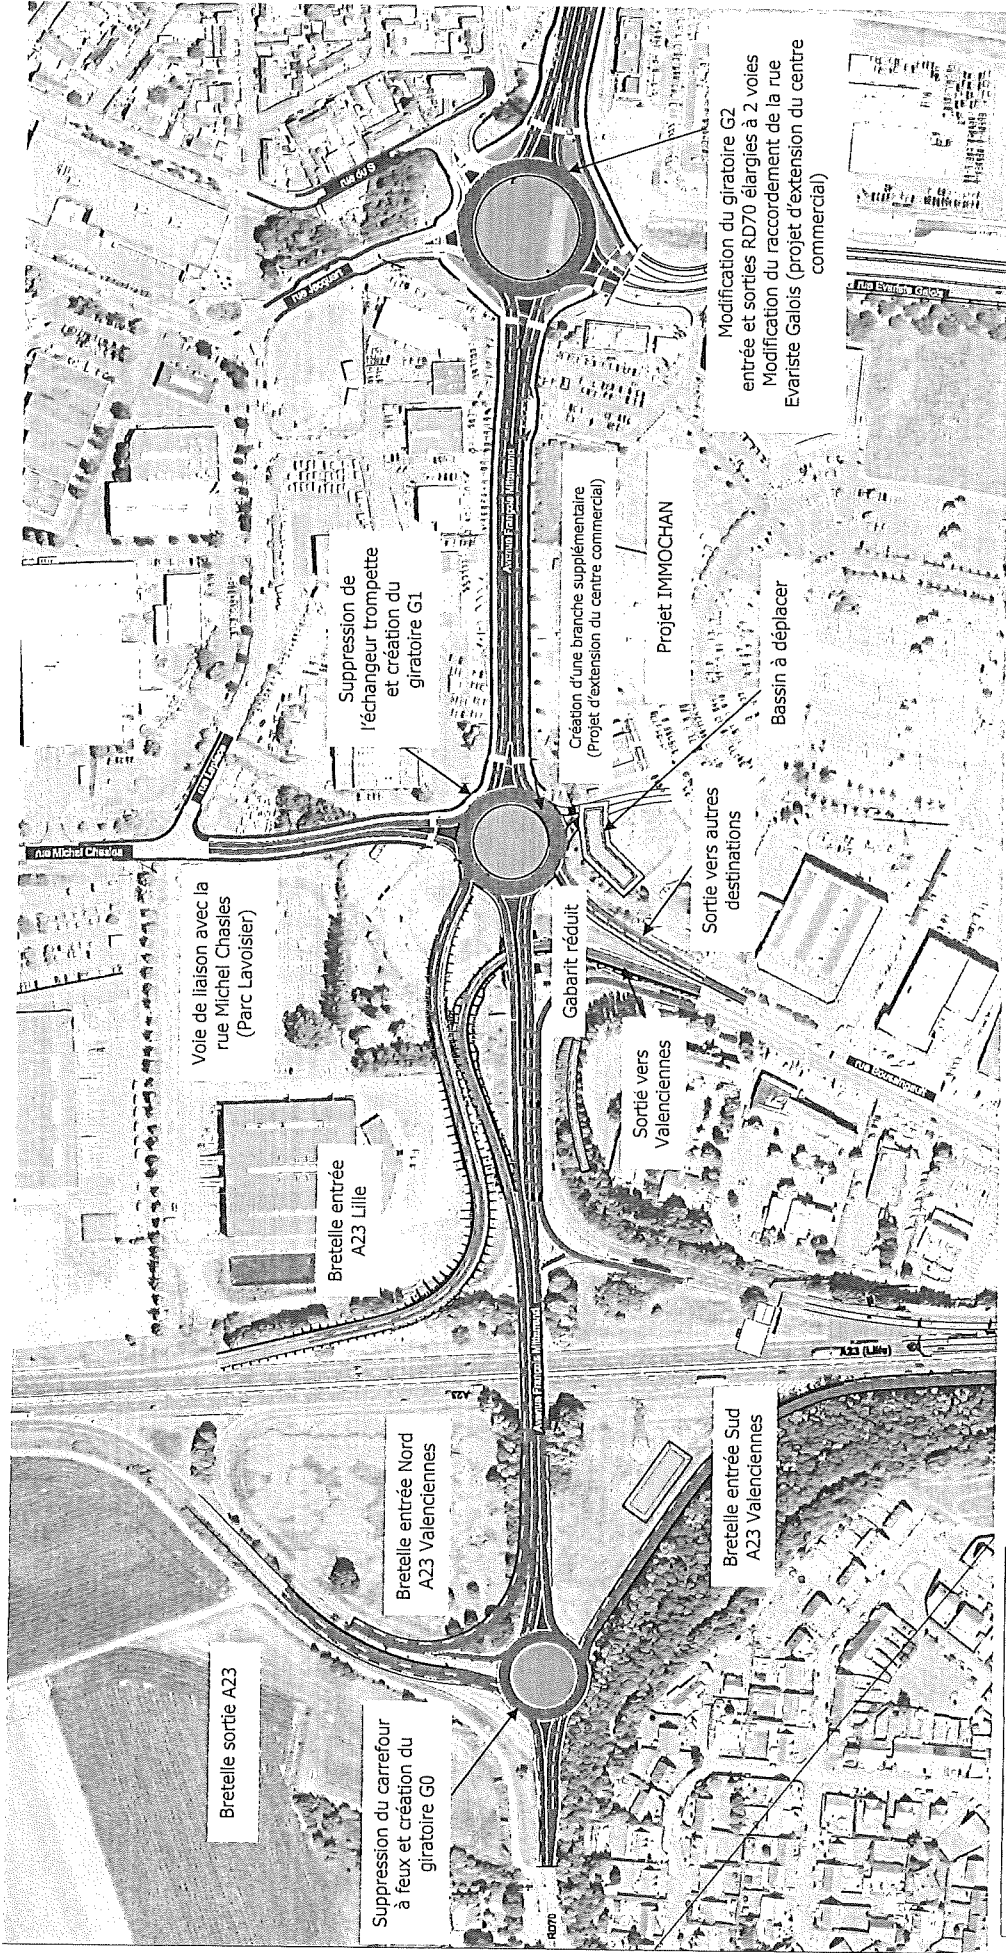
Plan de définition générale de l'aménagement (Section Ouest)
